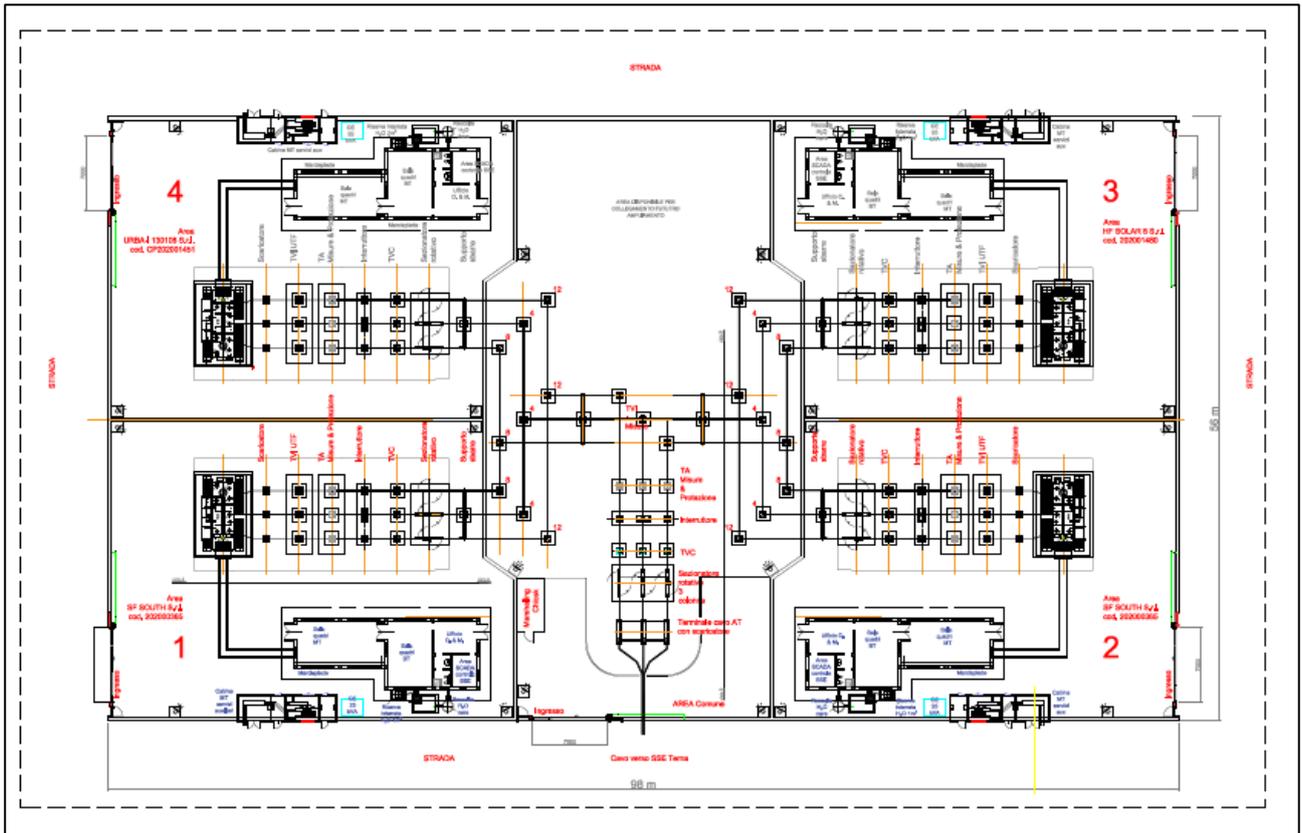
planimetria elettromeccanica Sottostazioni Elettriche di Utenza con rappresentazione delle Opere condivise
